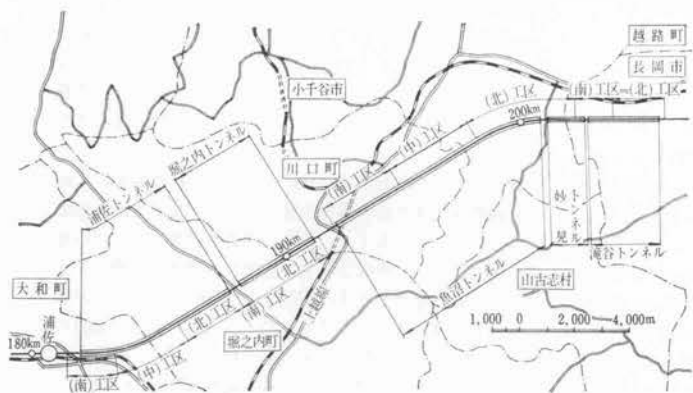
浦佐, 堀之内, 魚沼, 妙見および滝谷トンネル平面図
